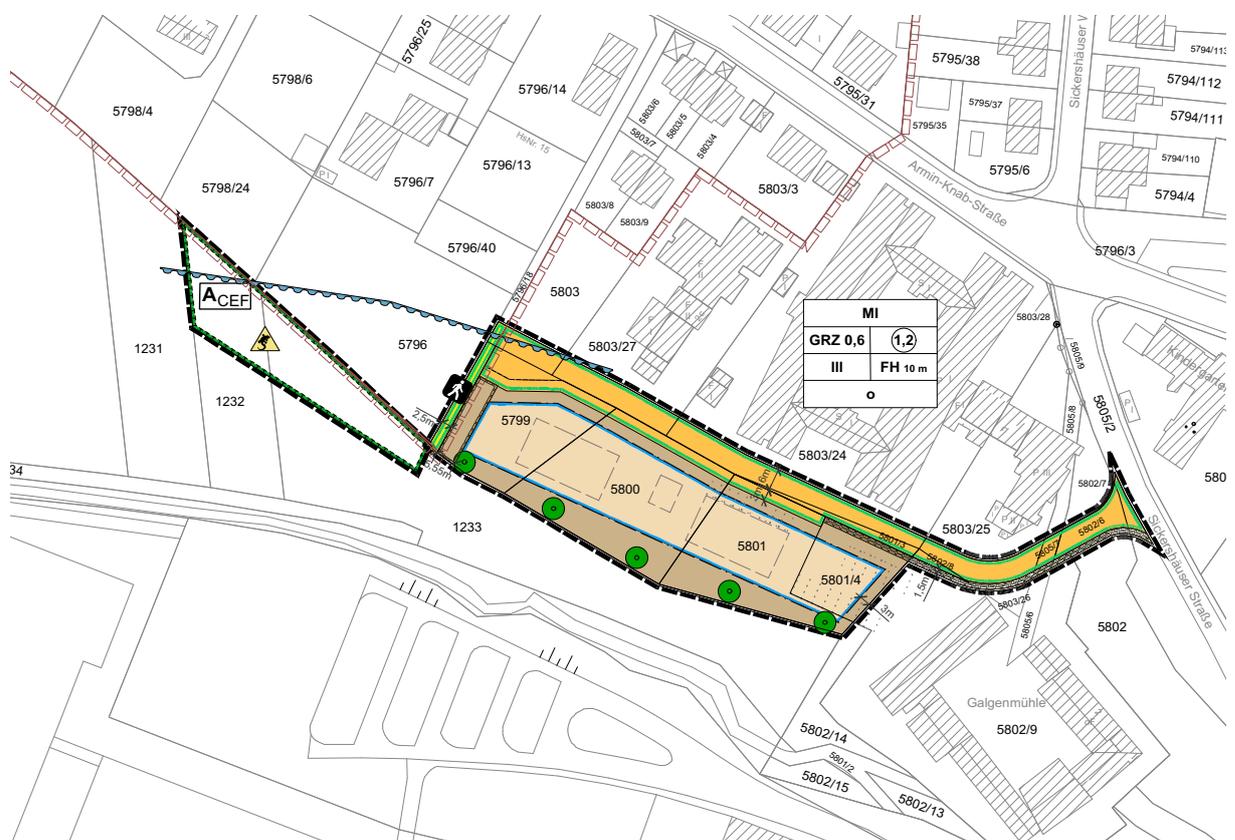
Entwurf Bebauungsplan, unmaßstäblich
